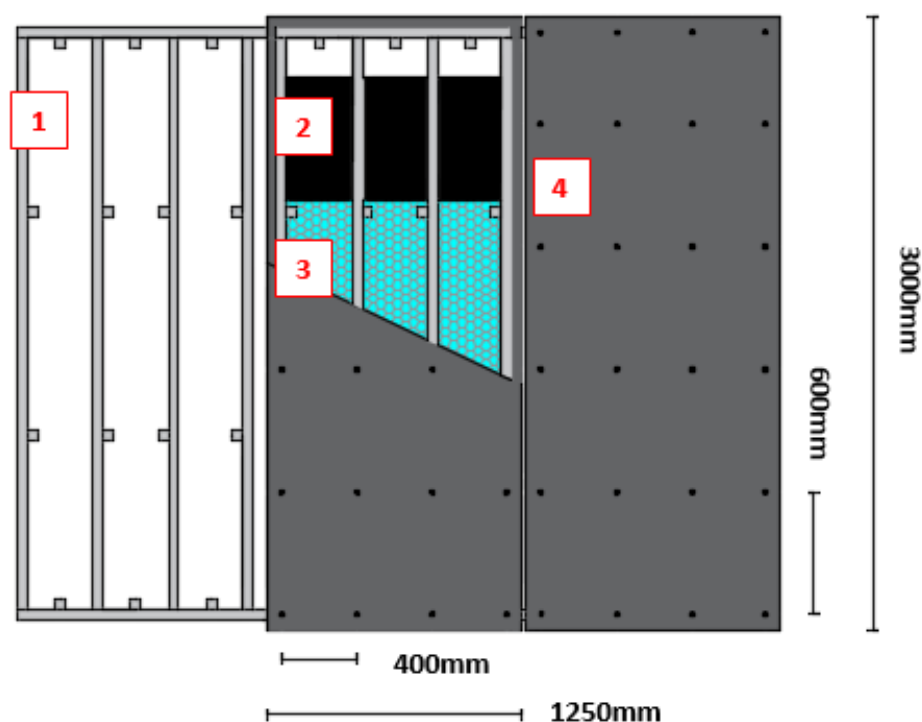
Esquema construtivo da fachada, U.S. Vilar Andorinho. 1 - Fachada ventilada; 2. Impermeabilização (Tela líquida); 3 - Isolamento térmico (40mm); 4 - Painel compósito de madeira e cimento (12mm).
